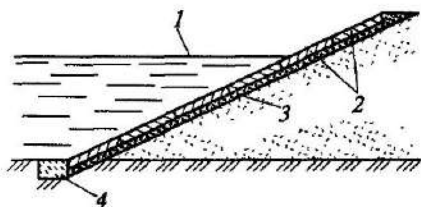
Укрепление откоса насыпи железобетонными плитами:
